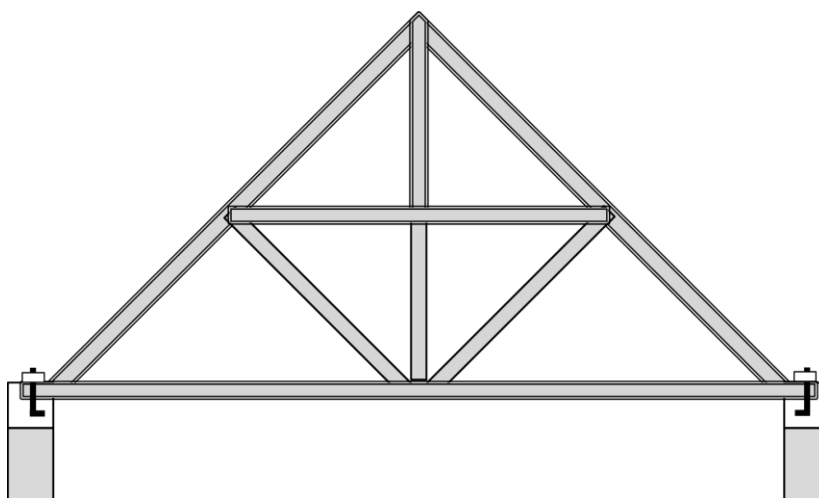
exemple d'ancrage de la toiture dans les chaînages
